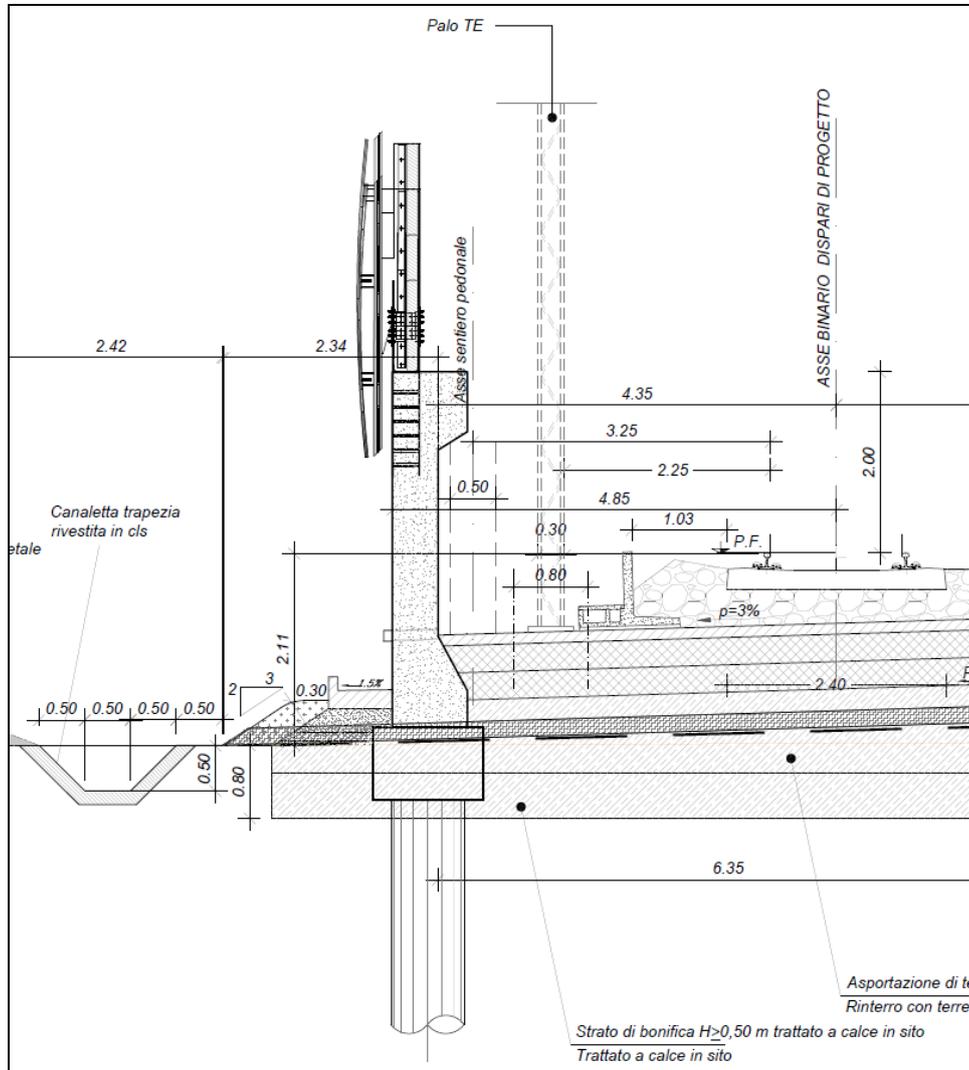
Particolare della BA Standard RFI verticalizzata installata sopra un muro antisvio. Il muro antisvio è caratterizzato da importanti opere di sottofondazione (pali di grande diametro).
